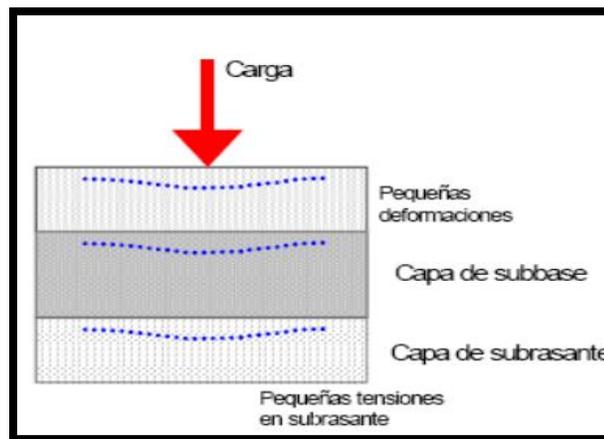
Elementos de un pavimento rígido (Altamarino k, 2007)
